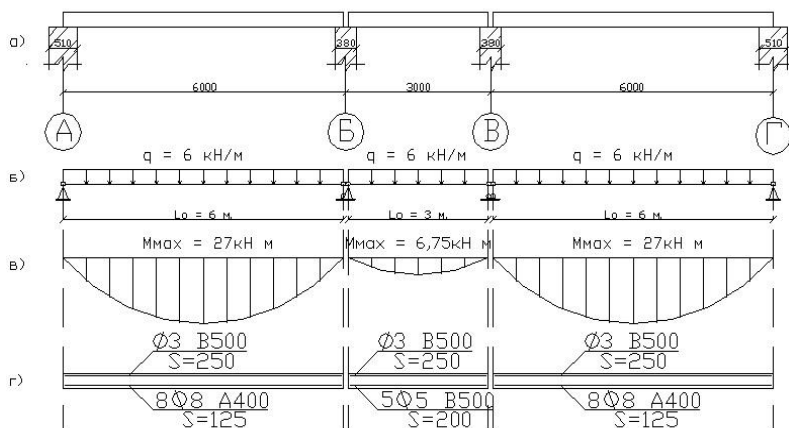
Конструктивная (а), расчетная (б) схемы, эпюры моментов (в), схемы армирования (г) для перекрытия. Вариант 1.
